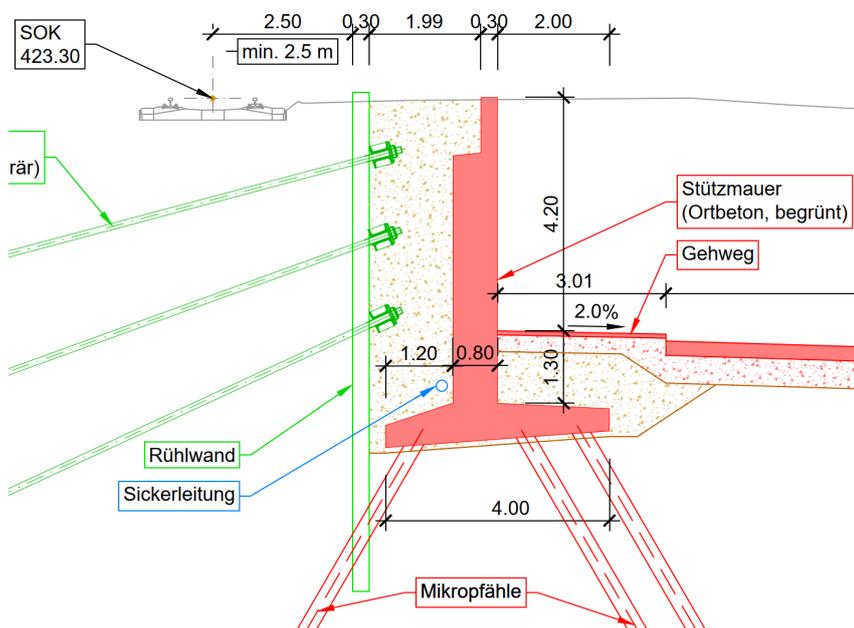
Querschnitt Stützmauer Bahntrasse (mit Baugrubensicherung)
